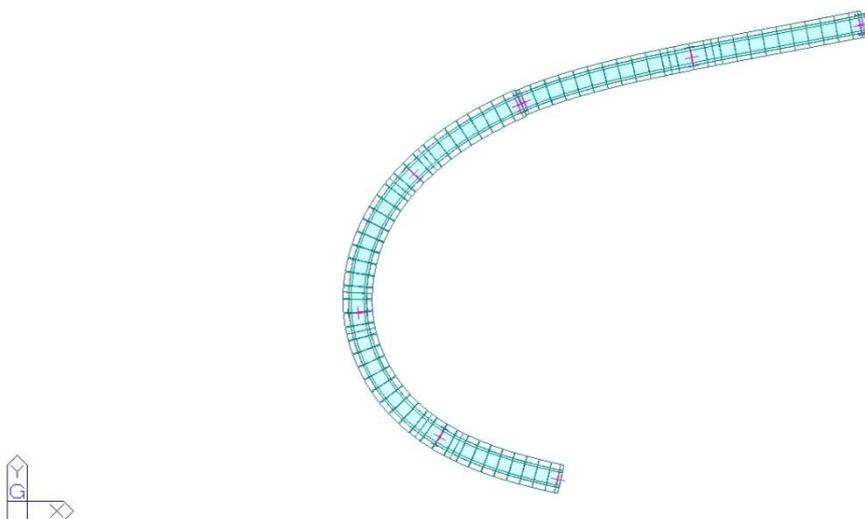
Direzione degli assi di incidenza del sisma rispetto agli impalcati A e B
